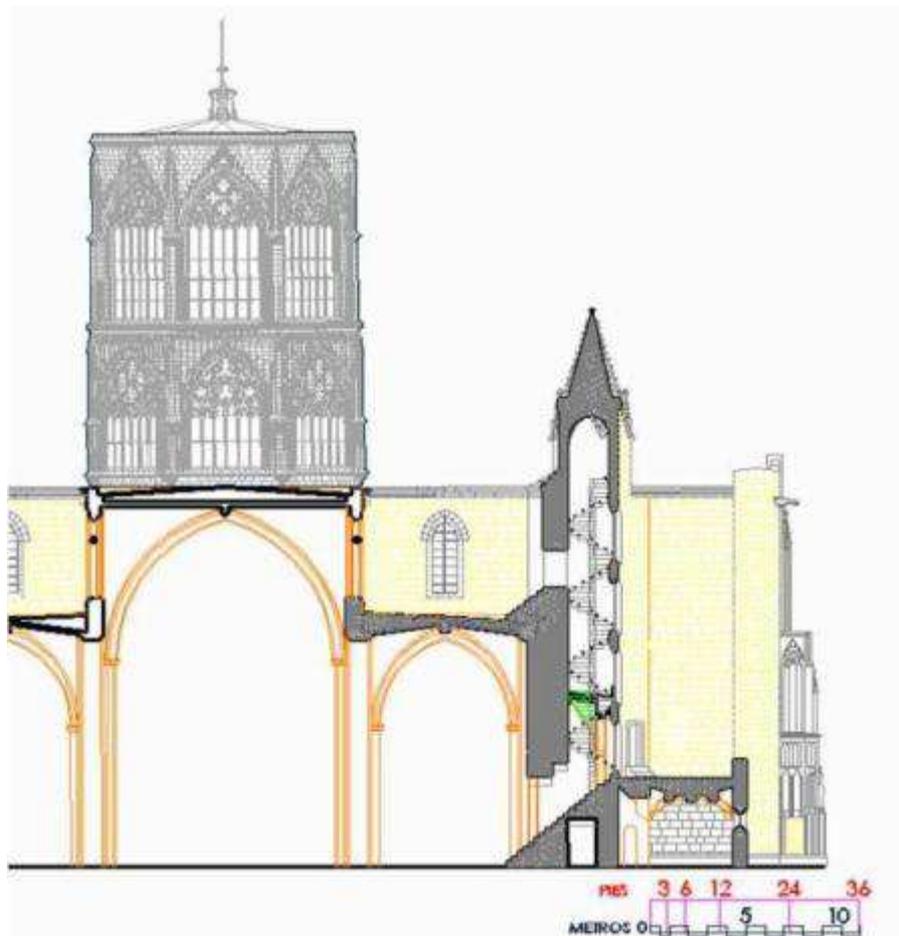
15.1 Sección por Sacristía Nueva. Construcción de la escalera de caracol.
